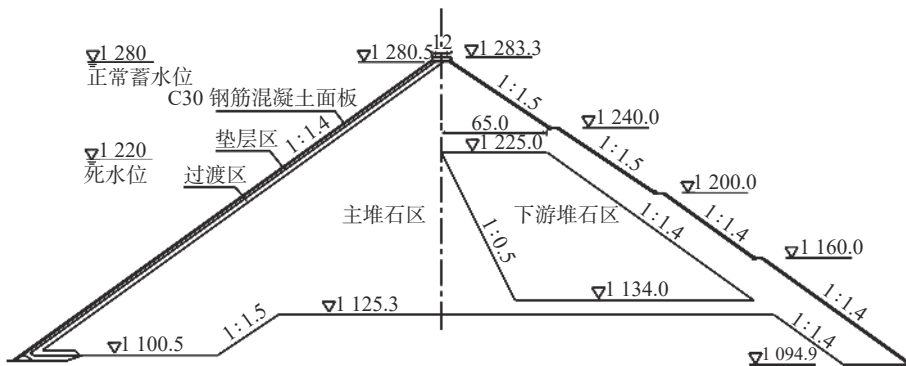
锅浪跷混凝土面板堆石坝标准横剖面图(单位:m)
